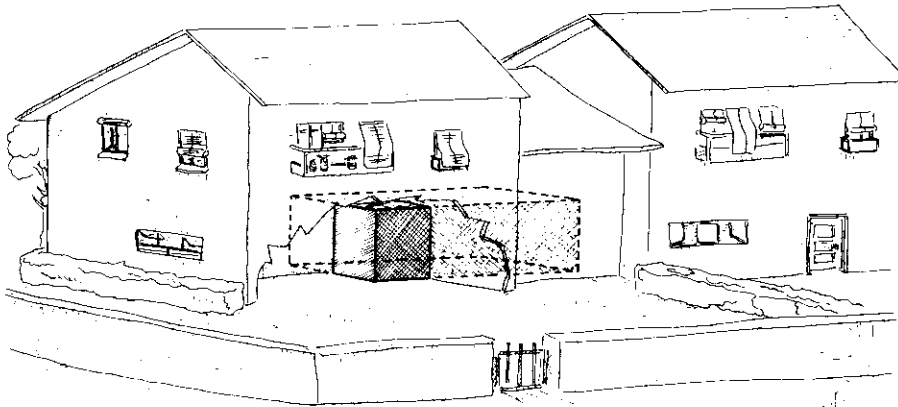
LA "ABERTURA" EN LA FACHADA PERMITE IMAGINAR LA DISPOSICION QUE DEBE TENER UN REFUGIO EN UNA CASA SIN SOTANO. EL ELEMENTO MAS DENSAMENTE RAYADO ES EL REFUGIO EN SI, Y ESTA COLOCADO APROXIMADAMENTE EN MITAD DE LA PLANTA. LA ZONA MENOS RAYADA SON AREAS AUXILIARES ACONDICIONADAS CON MATERIAL DE BLINDAJE.
